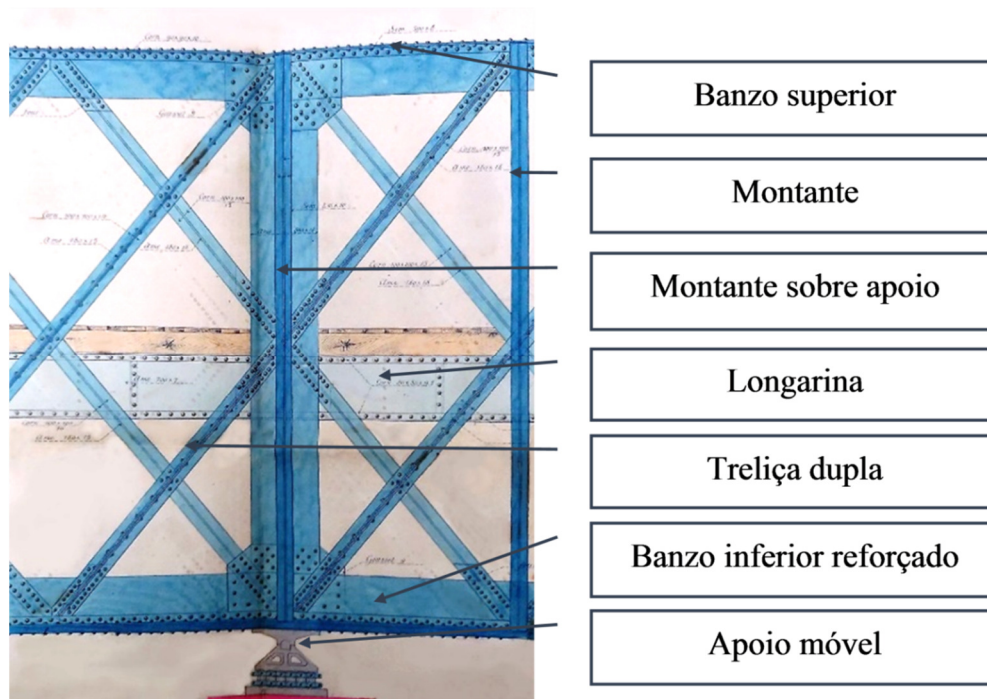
Identificação dos elementos constituintes de uma viga principal, adaptado de [64]
